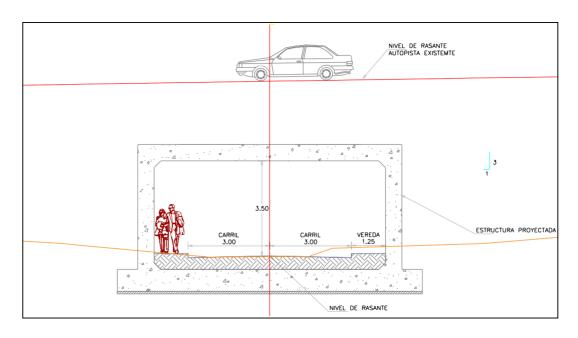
SECCIÓN TIPICA DEL PASO PEATONAL INFERIOR PROYECTADO
